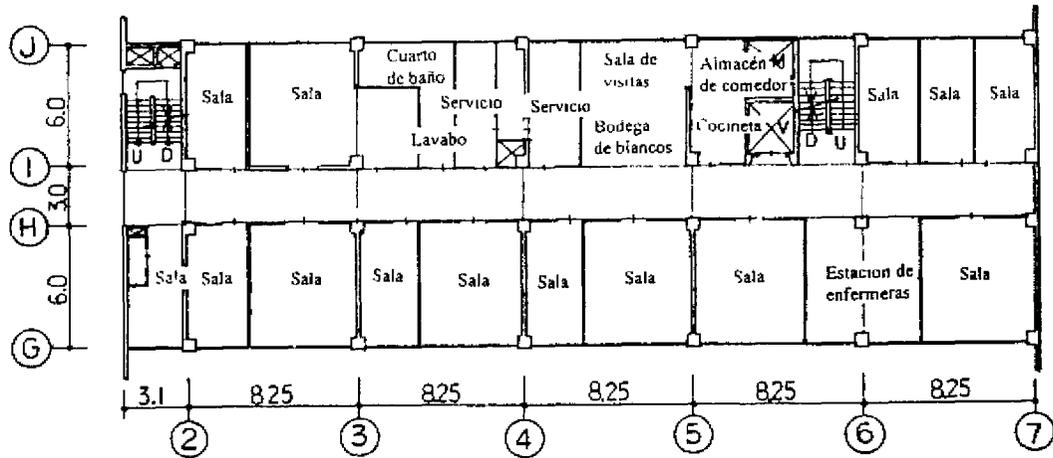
Planta del tercer nivel (Distribución de salas en el edificio de 5 niveles)
